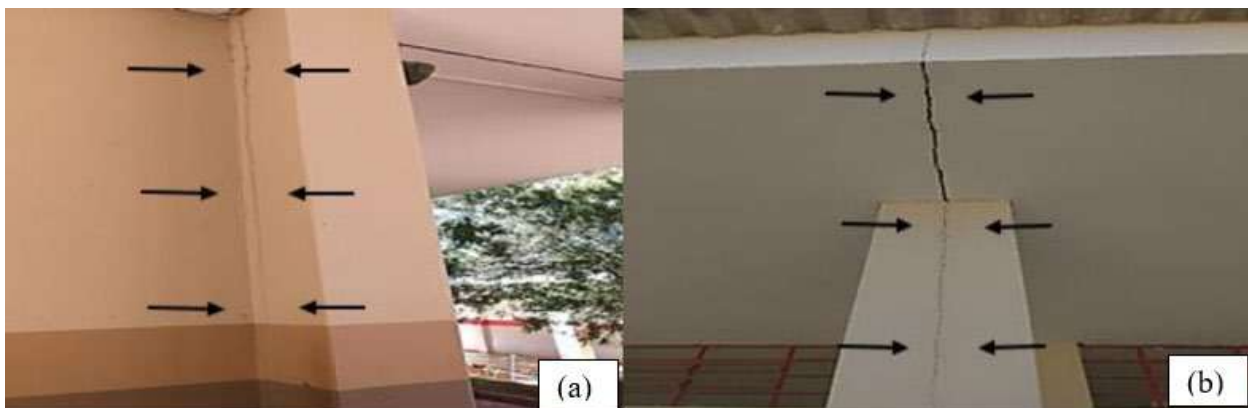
a) Trincas verticais em pilar: devido ao recebimento de carga. b) Trincas verticais na laje e pilar: excesso de carga.
